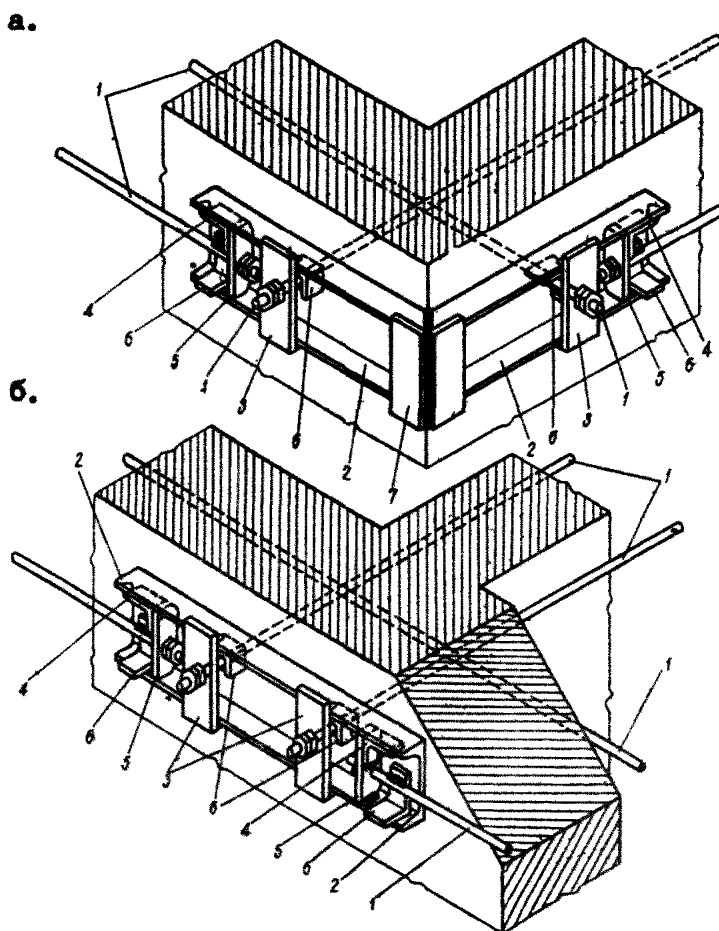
Схемы усиления цокольного пояса стен парными стальными тяжами и устройства обжимных элементов:
